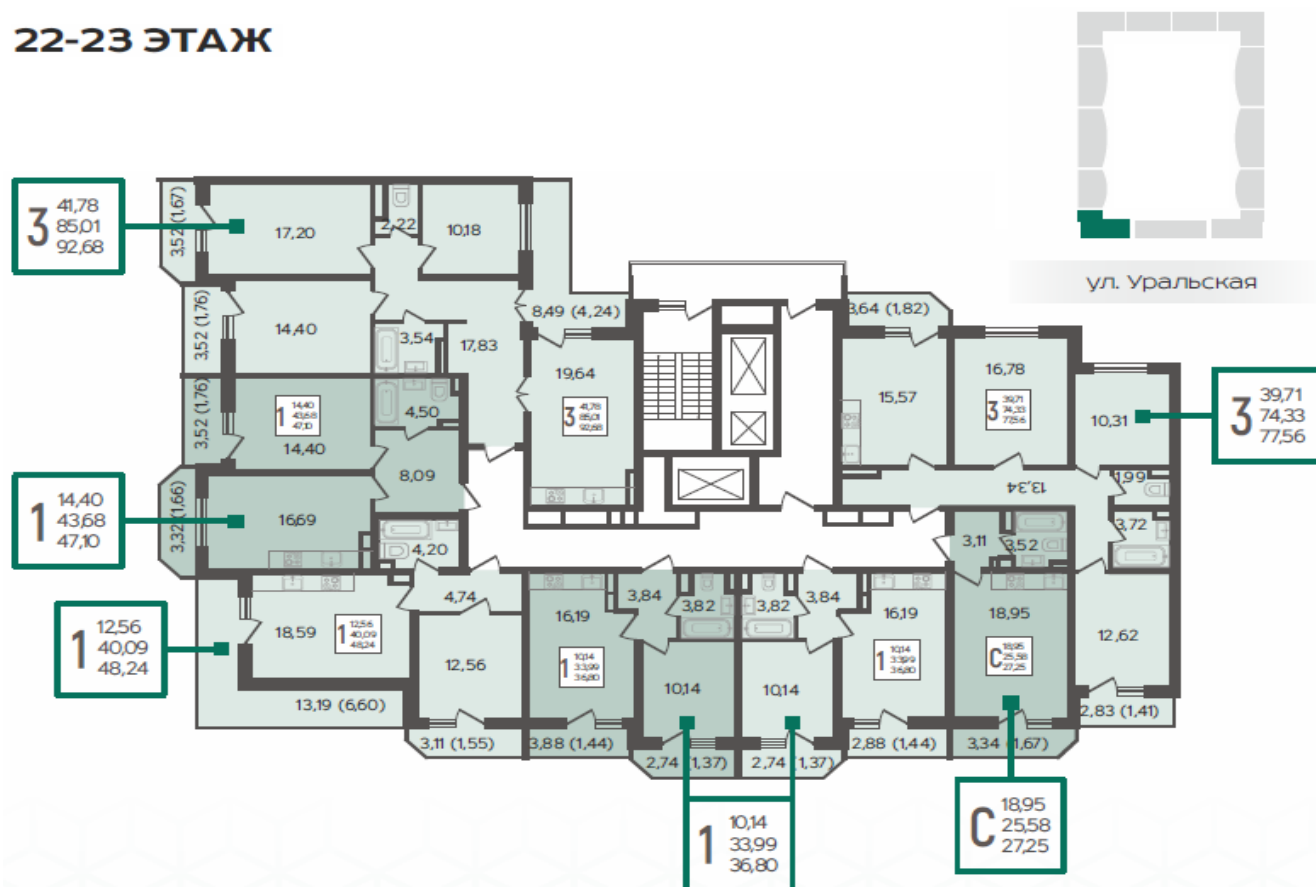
Типовой план 22-23 этажа БС-1 ЖК URAL
